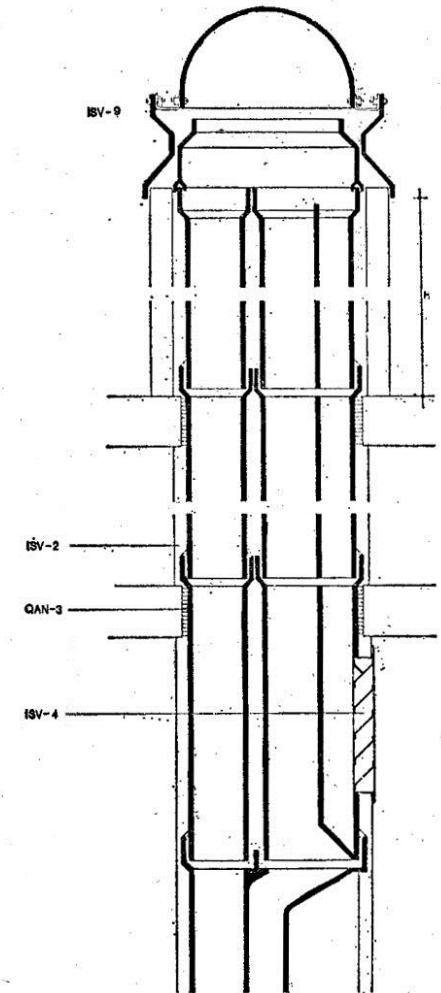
30 Conducto de elementos prefabricados H-Tipo.
